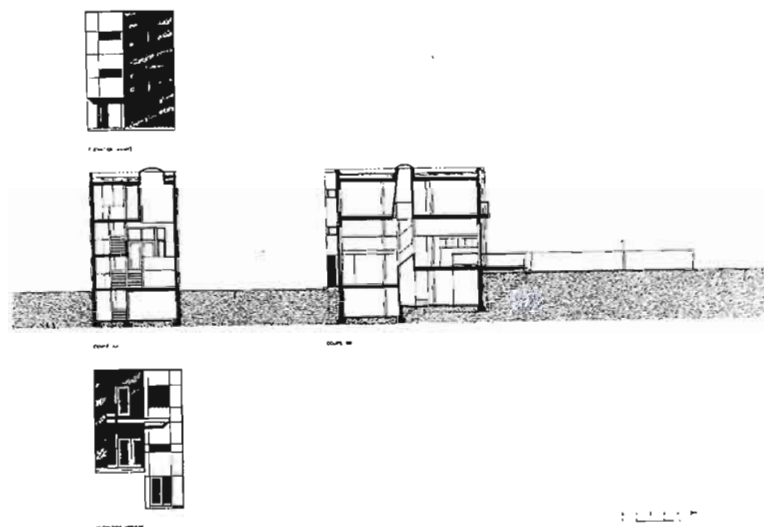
Plans des étages et vue en coupe du 4540, rue De Bullion. Source : Archives Marc Blouin.
